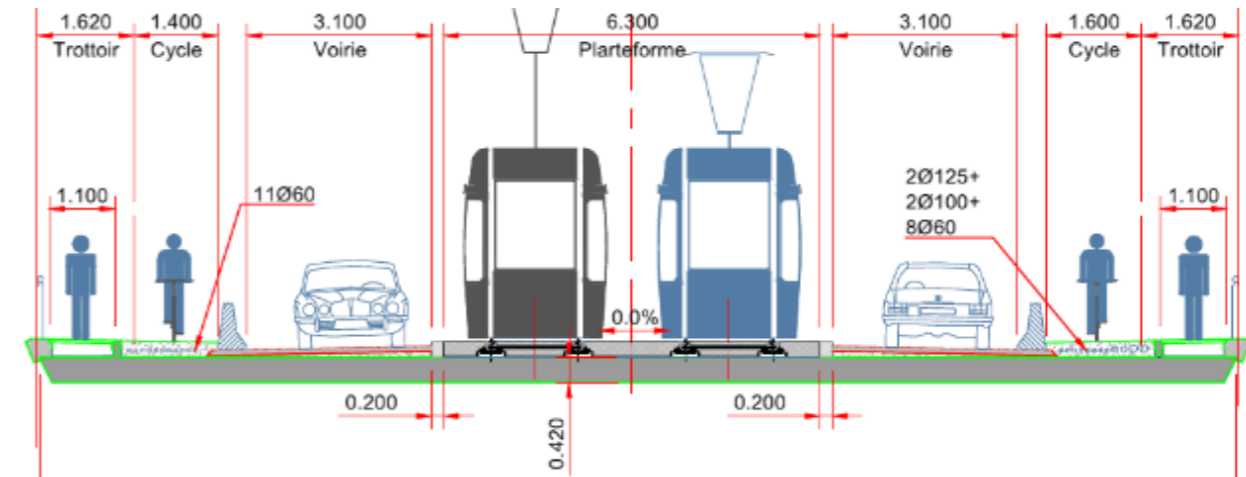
coupe transversale sur l'OA11 – Situation projetée
